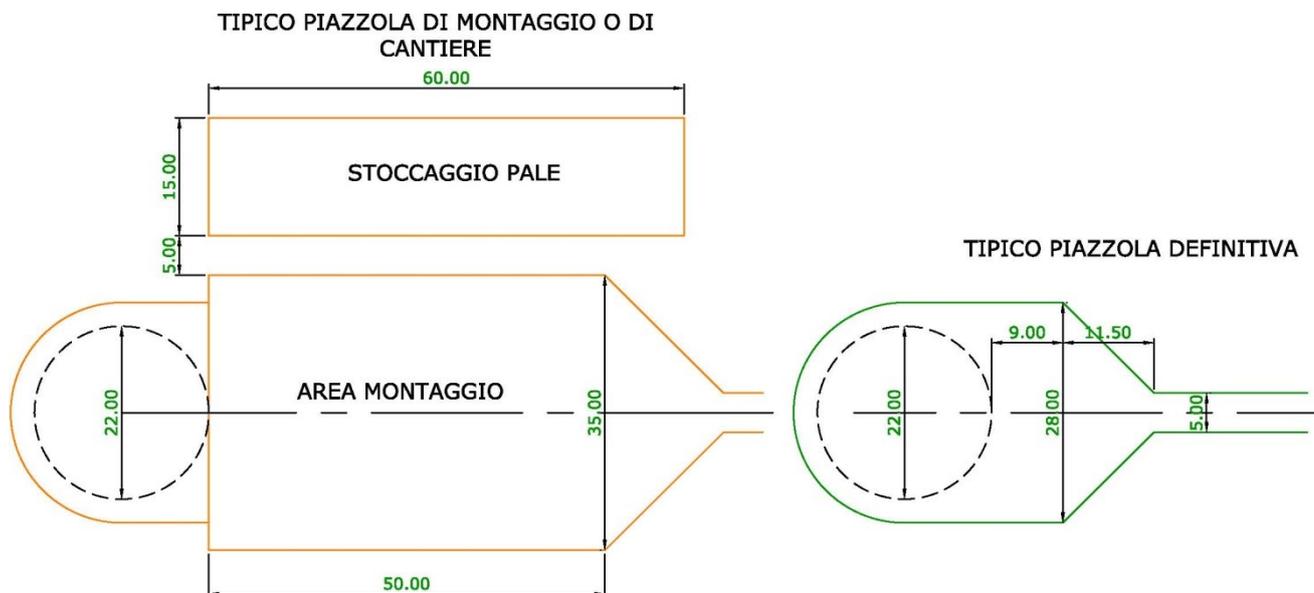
Tipiche Piazzole di Cantiere o Montaggio e Piazzola Definitiva
